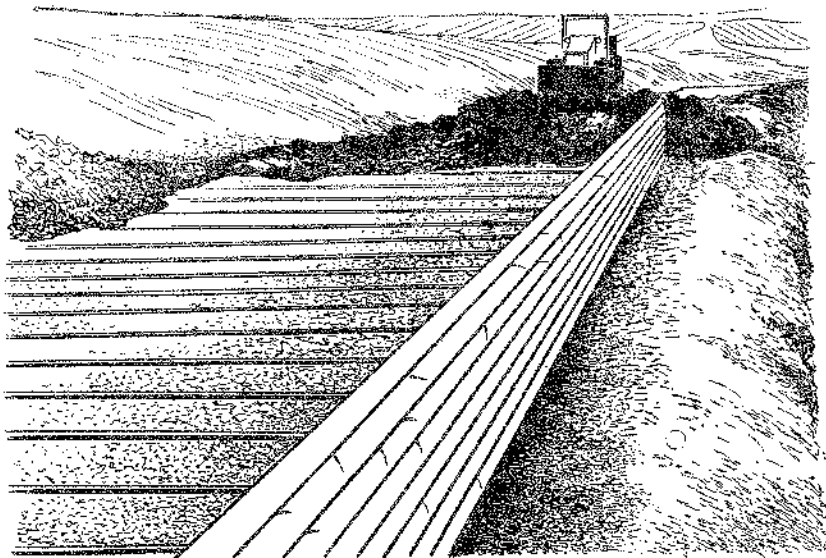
Подпорные стенки из армированного грунта (в процессе строительства)
